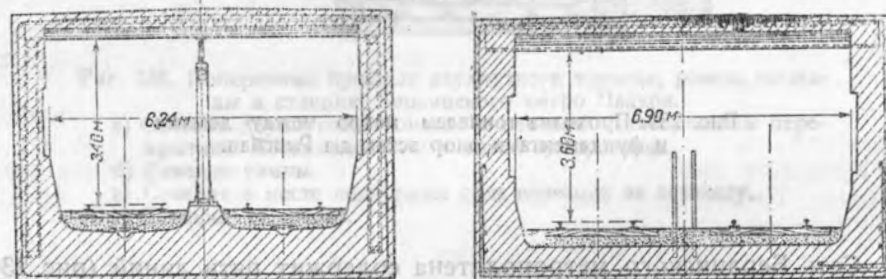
Поперечные сечения двухпутных тоннелей Берлинского метро с плоским перекрытием.
